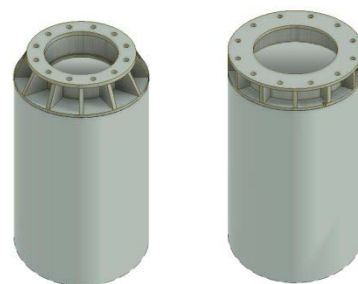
Узлы соединения фундаментных секций с промежуточными и анкерно-угловыми железобетонными опорами
